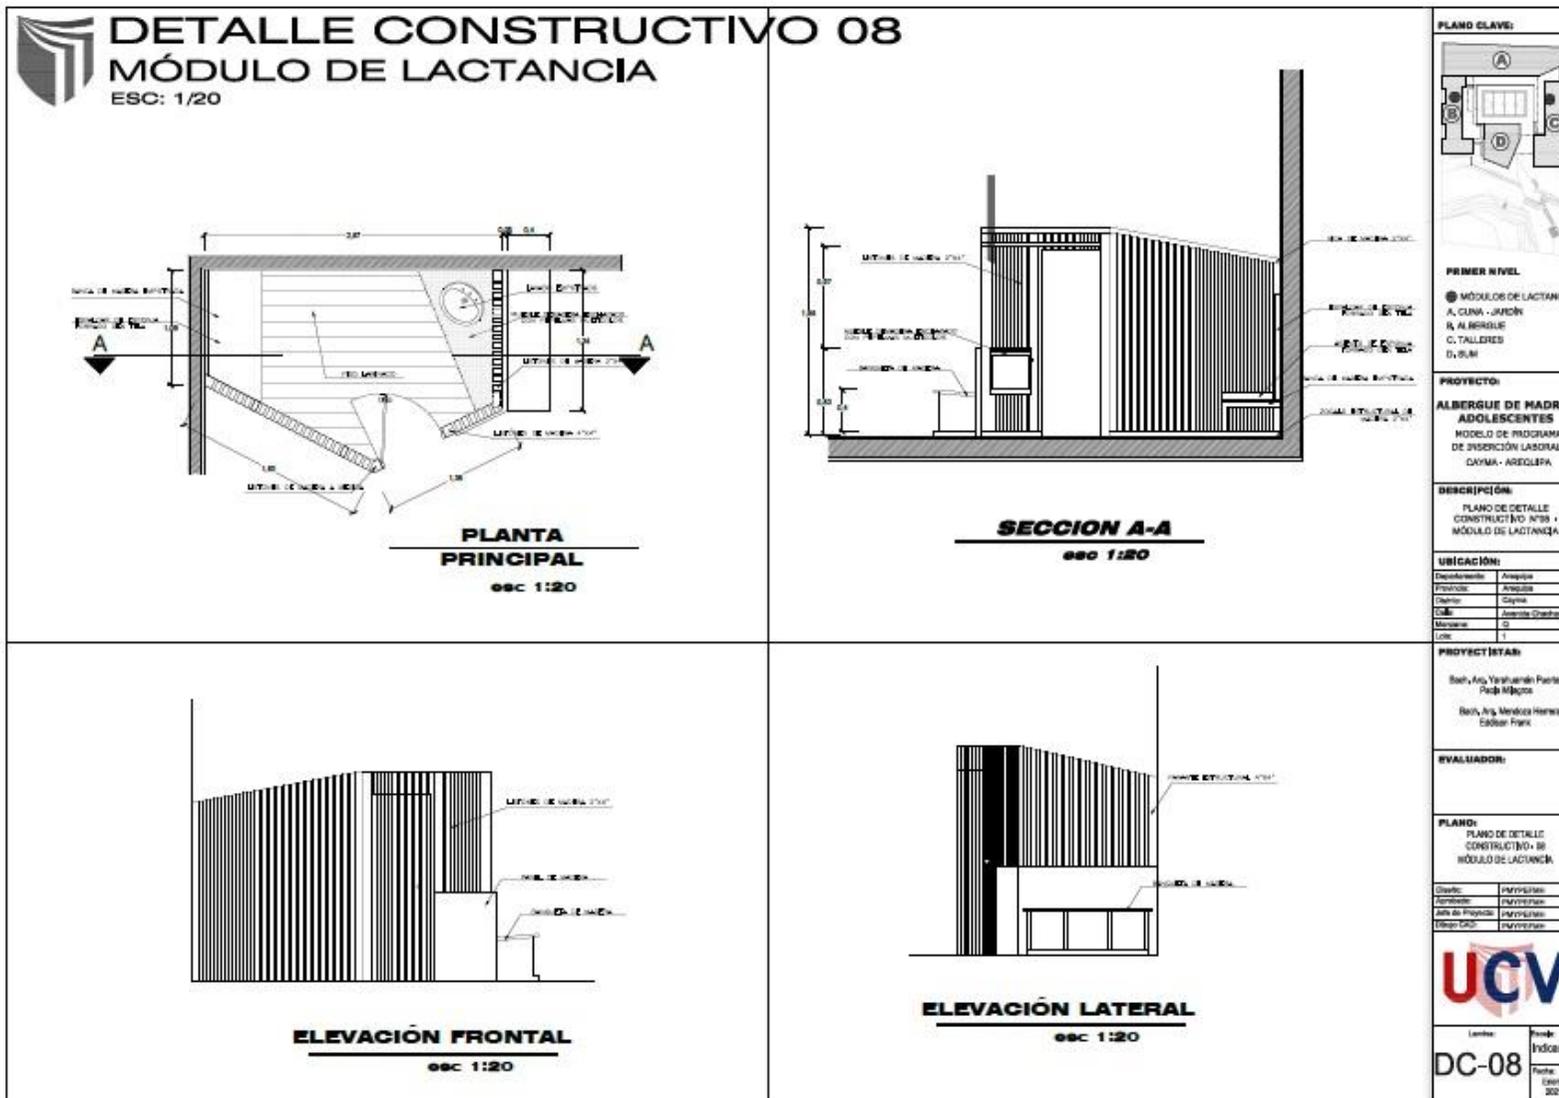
Detalle Constructivo 08 – Módulo de Lactancia DC-08.
